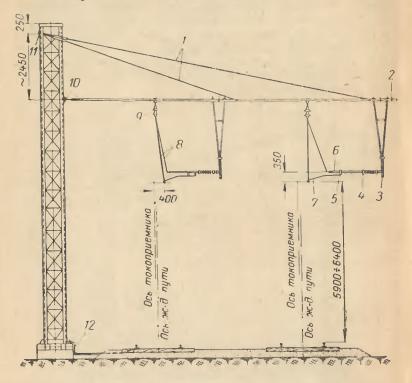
Подвеска контактного провода на двухпутной консоли. 1- тяги; 2- консоль; 3- фиксаторная стойка; 4- изолятор фиксаторный стержневой; 5- стойка сочлененного фиксатора; 6- фиксатор основной; 7- фиксатор дополнительный; 8- струны; 9- изоляторы подвесные; 10- узел крепления консоли к опоре; 11- узел крепления консоли к опоре; 12- заземленне конструкций подвесок.
